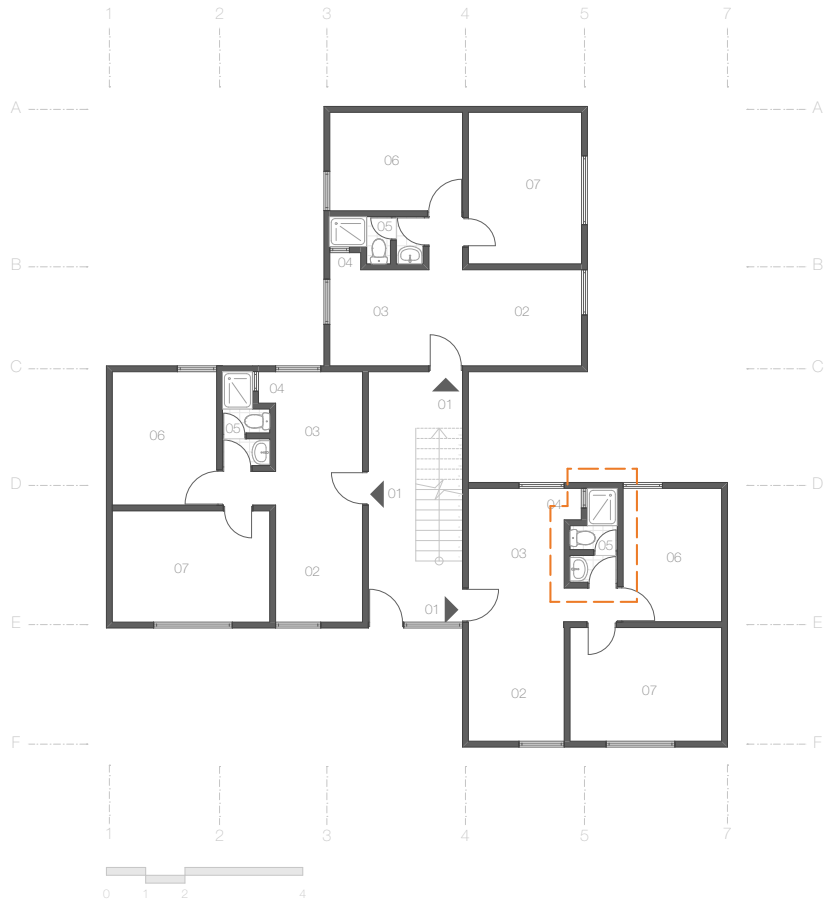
Multifamiliares Las Retamas Planta Tipo
